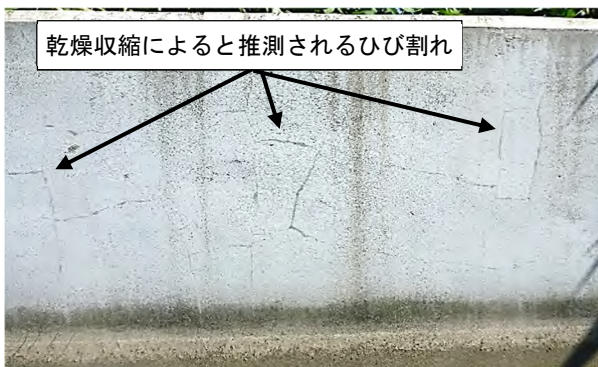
無機系被覆工法に生じた乾燥収縮ひび割れ
